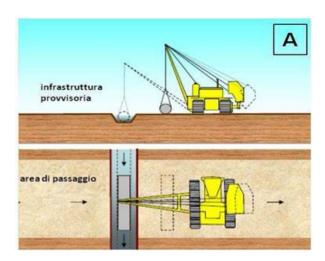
/A - Sezione tipo di un by-pass provvisorio del flusso idrico. Fase 1
